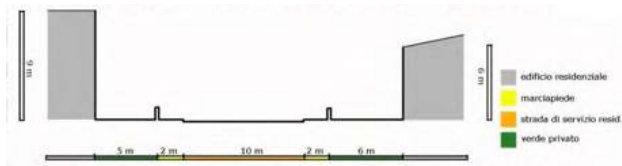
Sezione stradale tipo con gli edifici a schiera. Fonte: Lo Brutto A. M. (2018)
